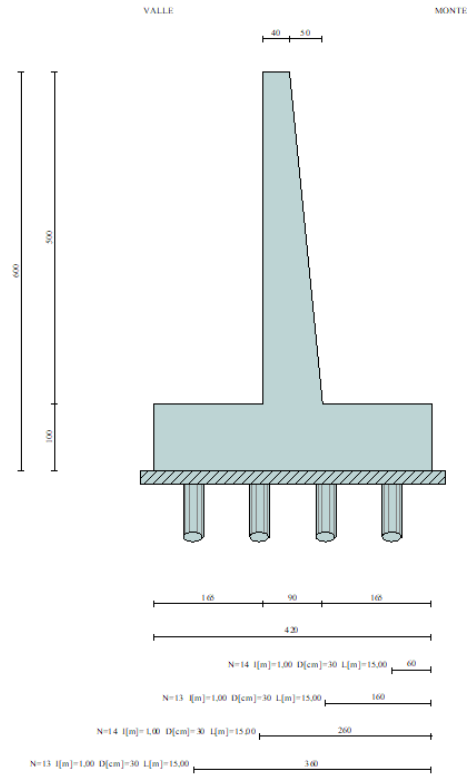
Muro Tipo D: geometria del muro di sostegno.
